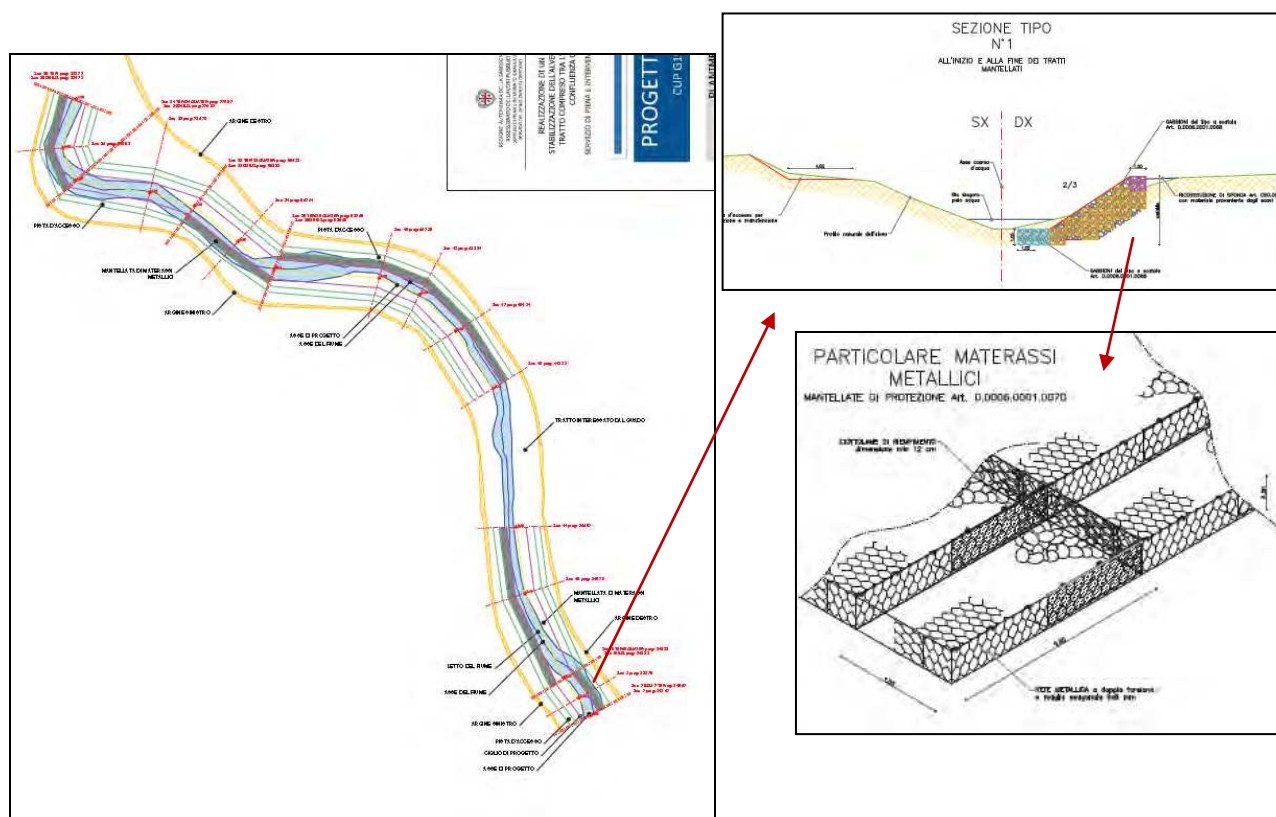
Planimetria generale dell'intervento di ripulitura con dettaglio delle sezioni e delle gabbionate metalliche.
